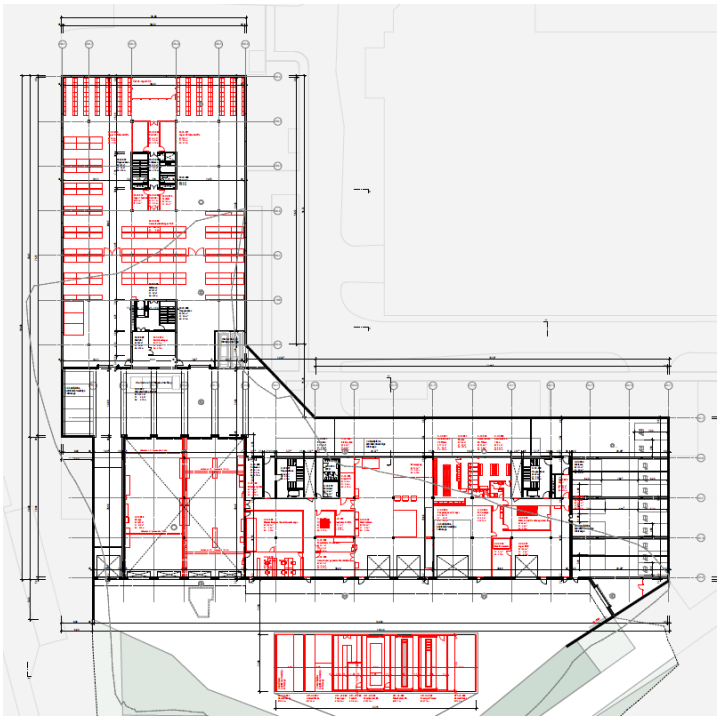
Grundriss UG2 (Quelle: Bauspektrum AG).
